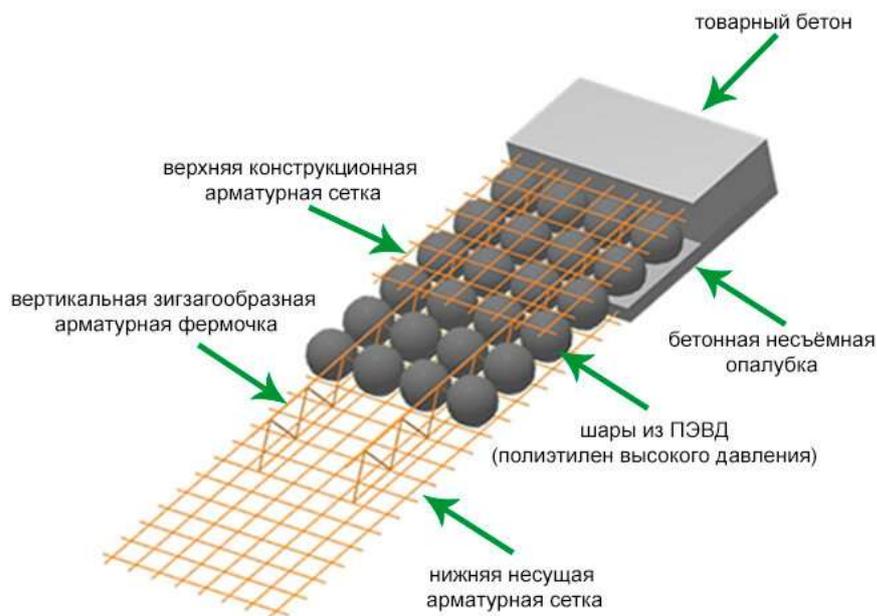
Перекрытие «BubbleDeck» Йоргена Брёнинга
